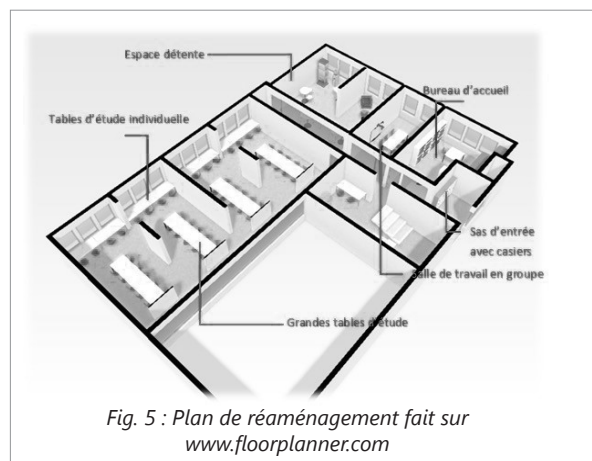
Plan de réaménagement fait sur www.floorplanner.com
